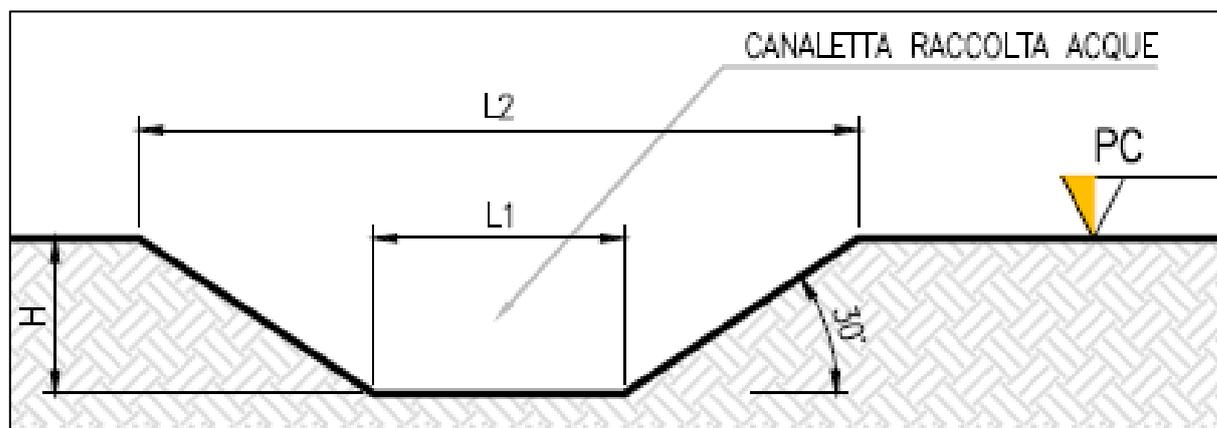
Sezione tipologica canaletta di drenaggio realizzata in scavo
